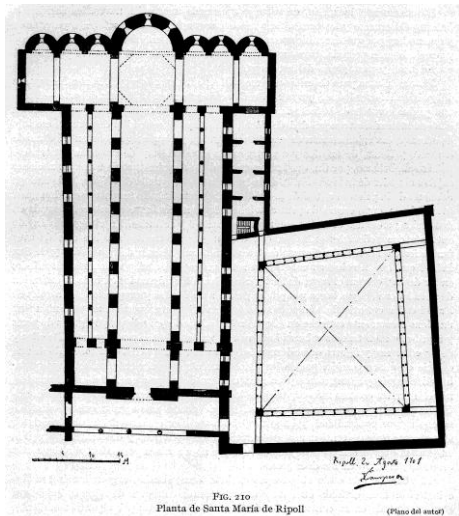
Planta de Santa María de Ripoll (Plano del autor)
